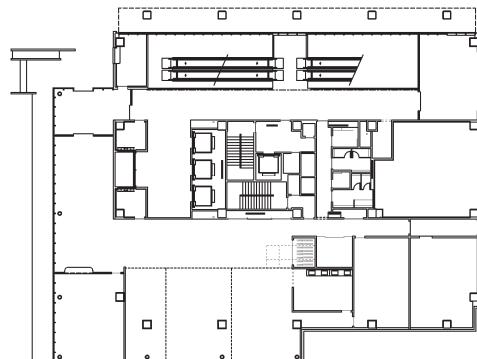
(2) 講義棟平面図（地上 3 階～7 階）(2/2)
